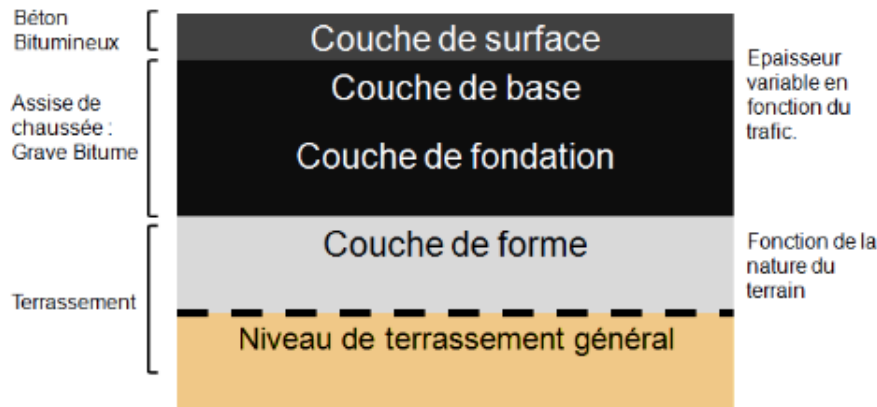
Constitution d'une chaussée bitumineuse épaisse.
